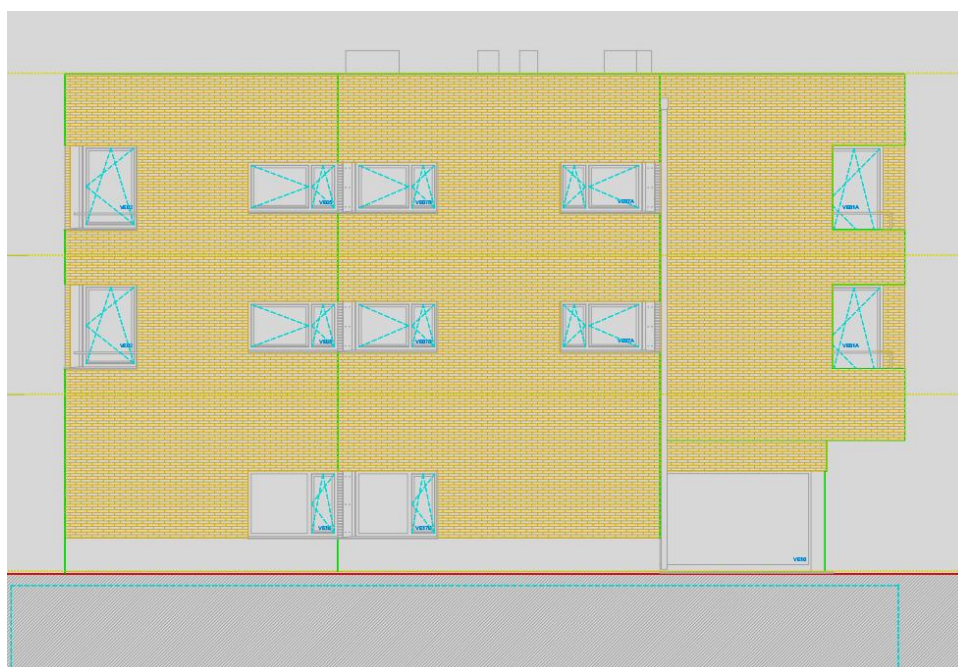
Alçado poente (FONTE: Ficheiro AutoCad – projeto de arquitetura)
